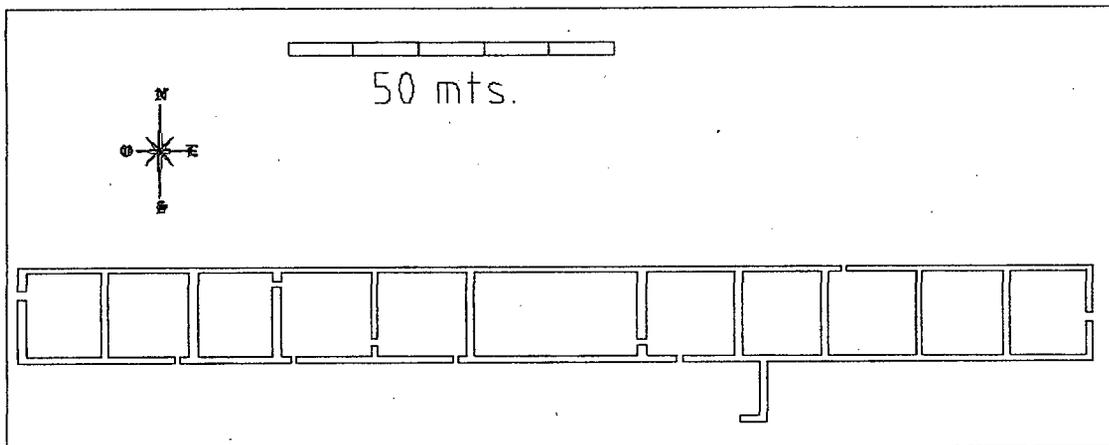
Plano de Ranchillos 1. Modificado sobre la base de Sempé (1973).
